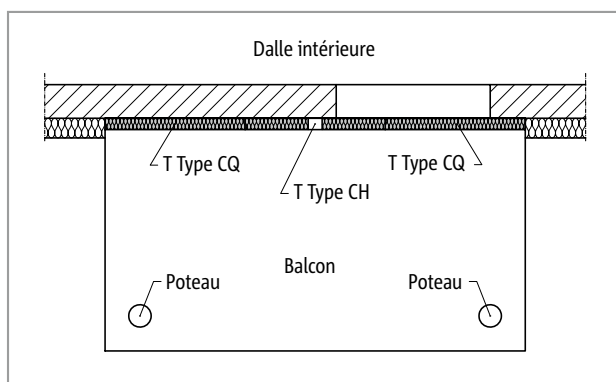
Schöck Isokorb® T Type CH : balcon sur poteaux
